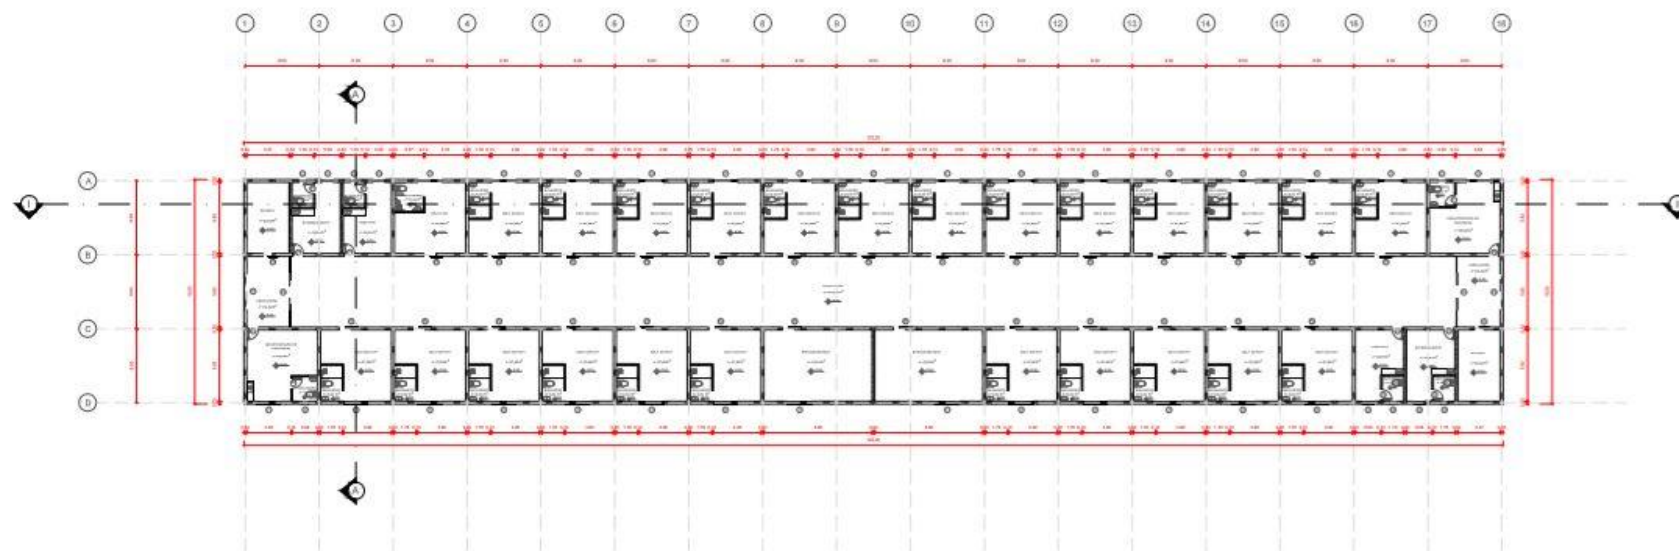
Planta Técnica – Fonte: Acervo Próprio
